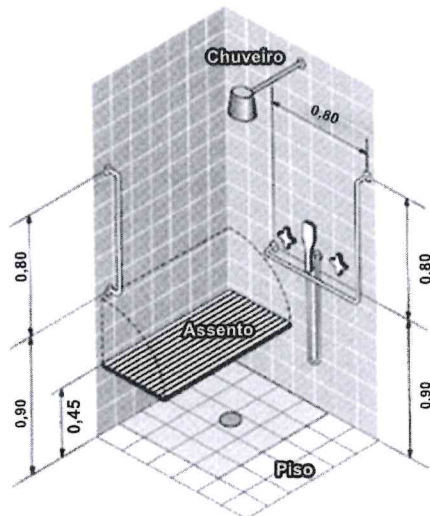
IMAGEM REFERÊNCIA: BARRAS DE APOIO RETA E TIPO "L", ASSENTO RETRÁTIL PARA BOX DE BANHO
